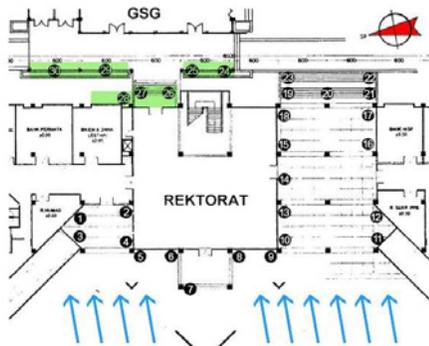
Ruang luar di lokasi depan bangunan rektorat
